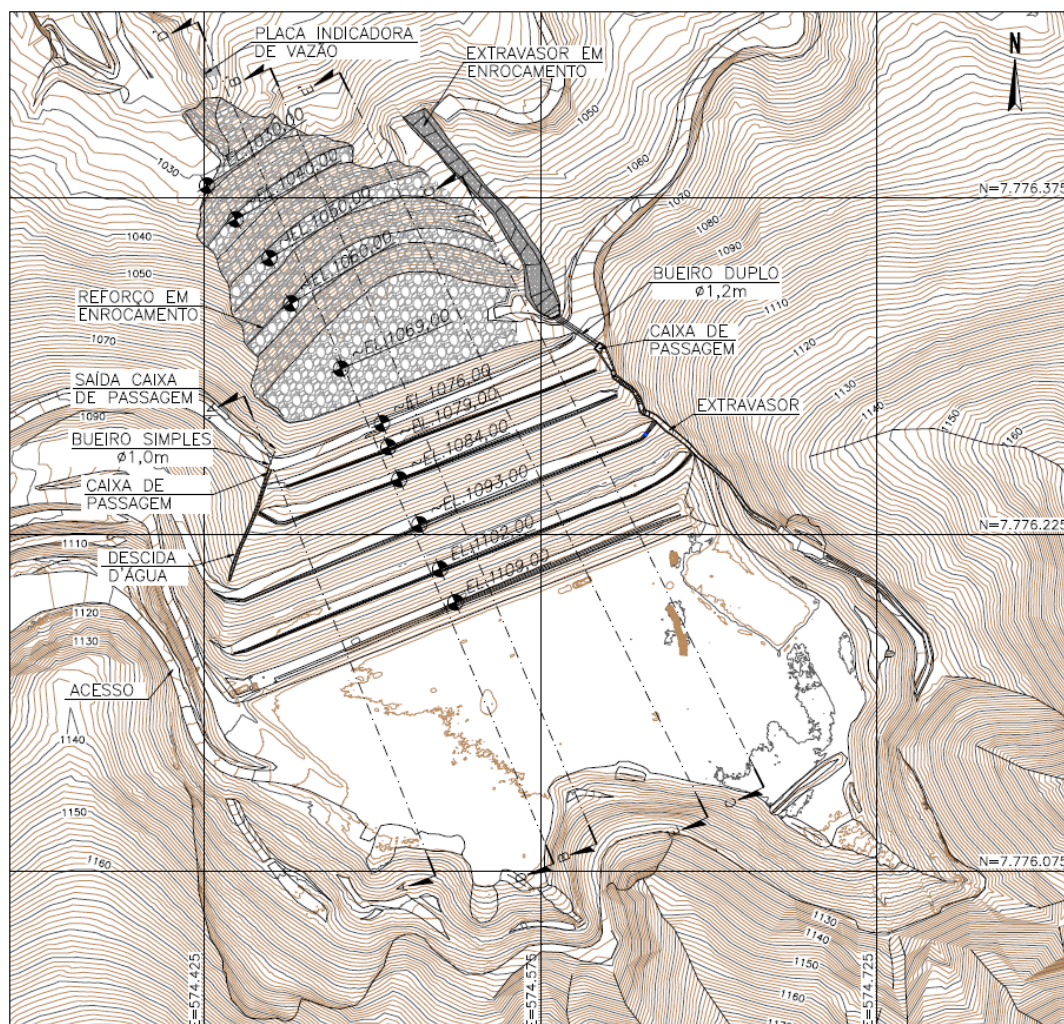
Levantamento topográfico 30/10/2025 – Obras Executadas - Planta.
